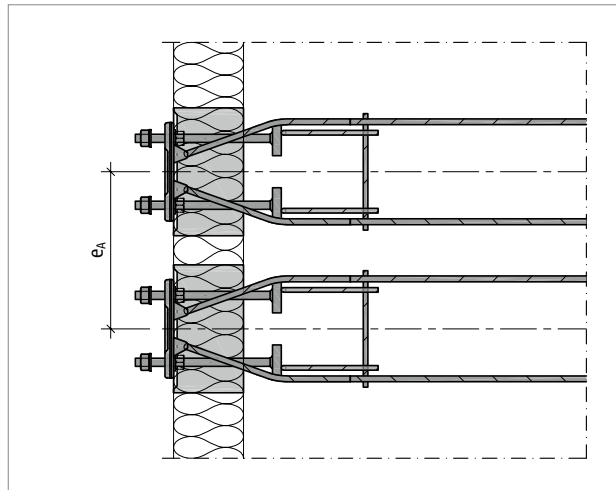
Schöck Isokorb® XT type SQ : espacement axial
